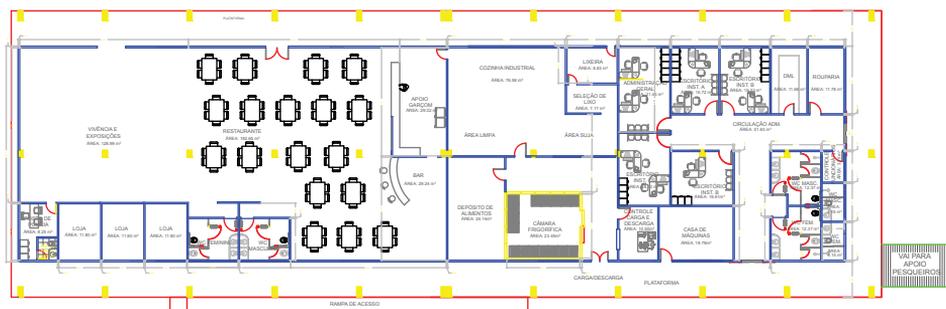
Planta baixa do bloco de apoio ao turista – Bloco 01
